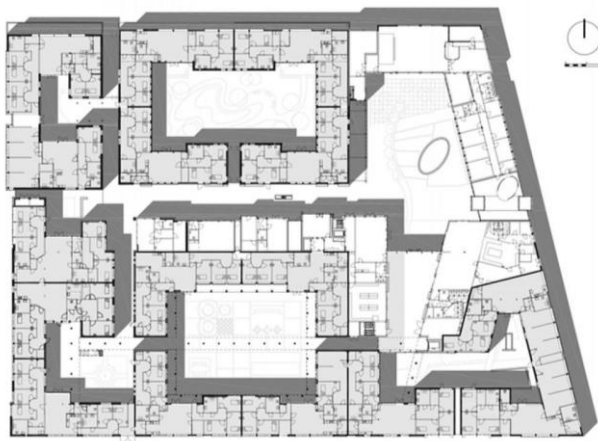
Buro Kade, *Plan de Hogeweyk*, s.d., plan, Dementia village associates.
